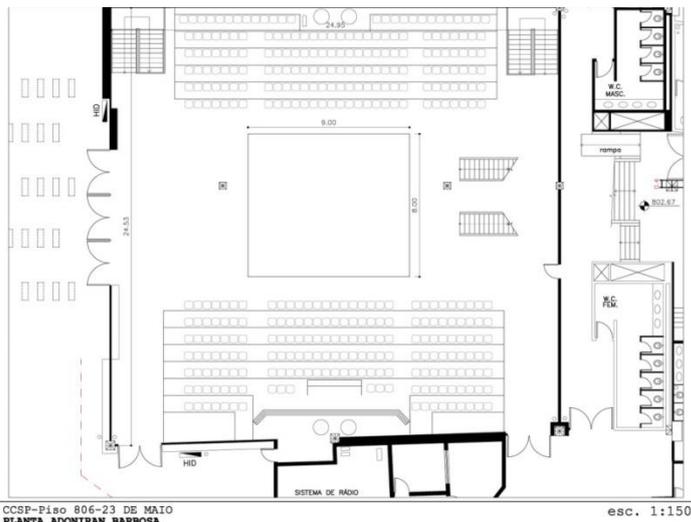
Rampas de Acesso. Fonte: archdaily.com.br.
